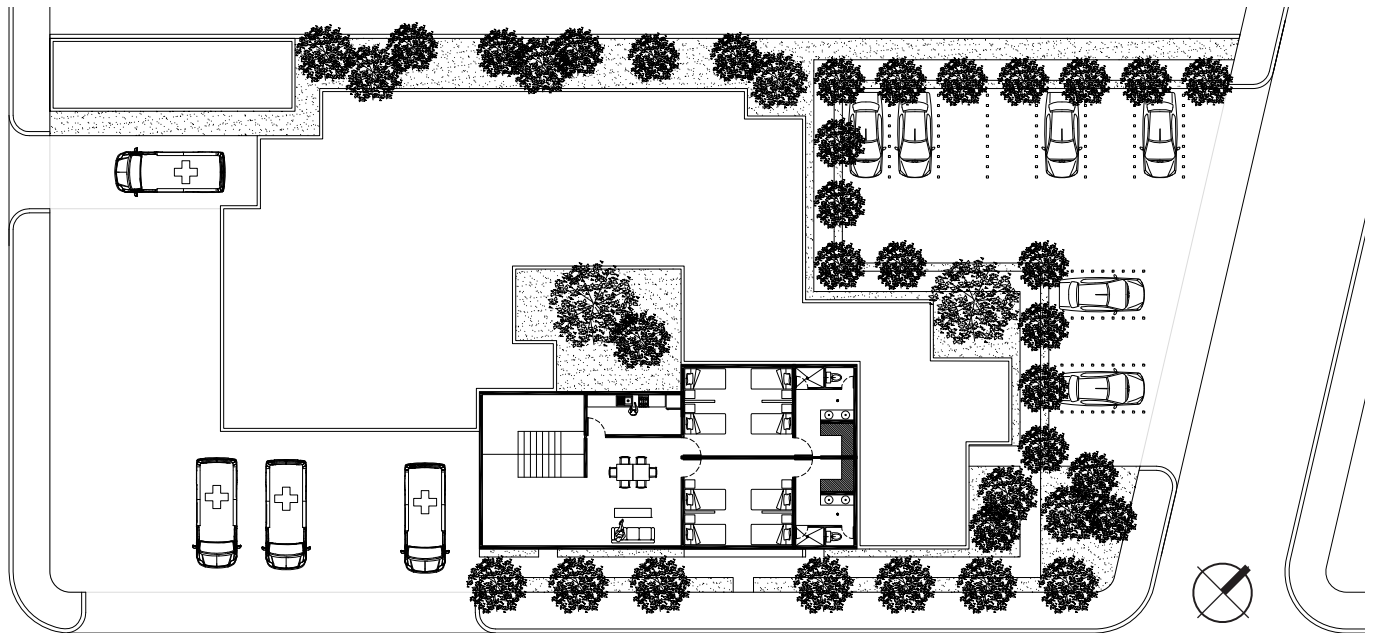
| Prototipo Delegación Media para el grupo climático dos | Planta Baja
